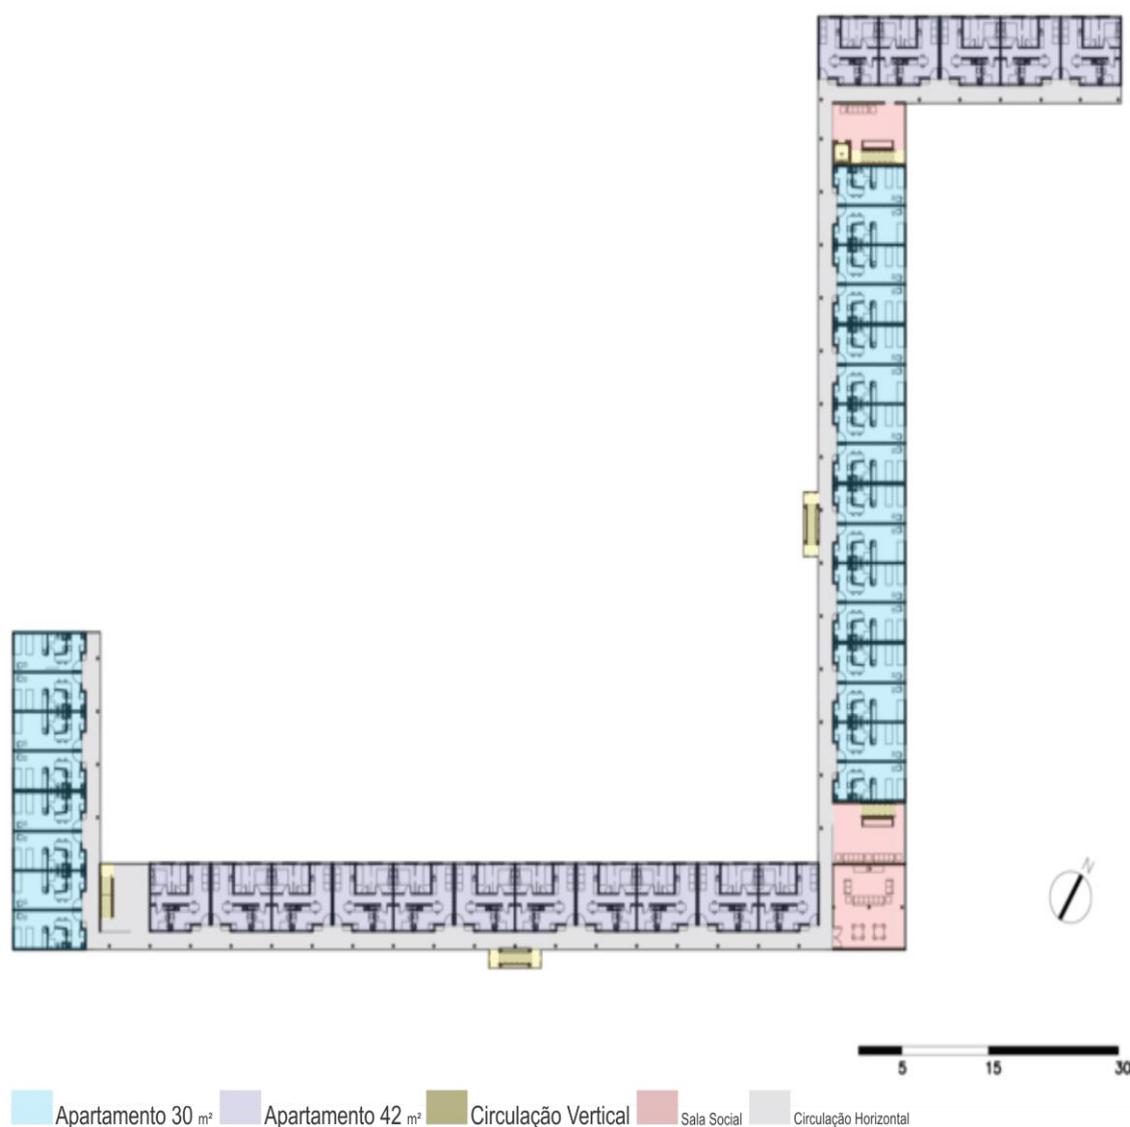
Planta baixa de implantação da Vila dos Idosos de São Paulo
